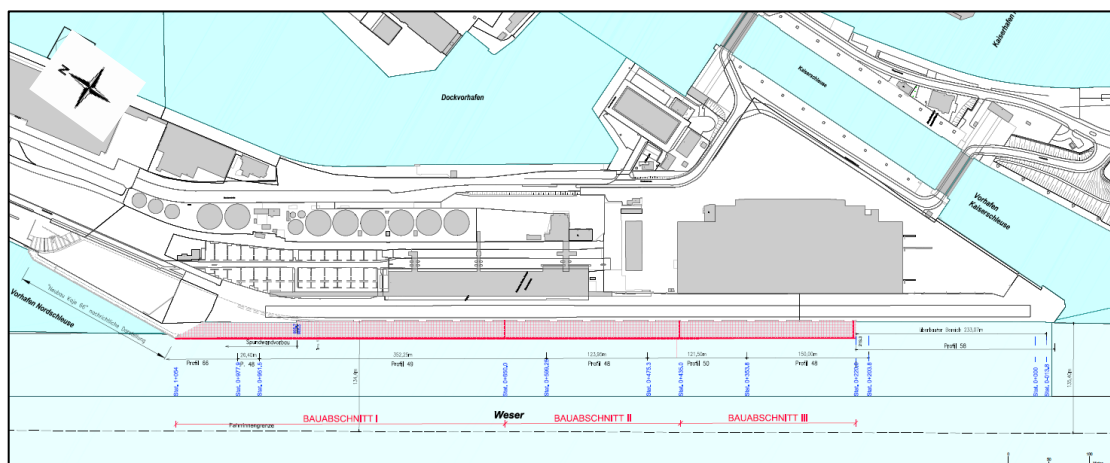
Übersichtslageplan, bremenports GmbH & Co. KG, Stand 23.04.2020
